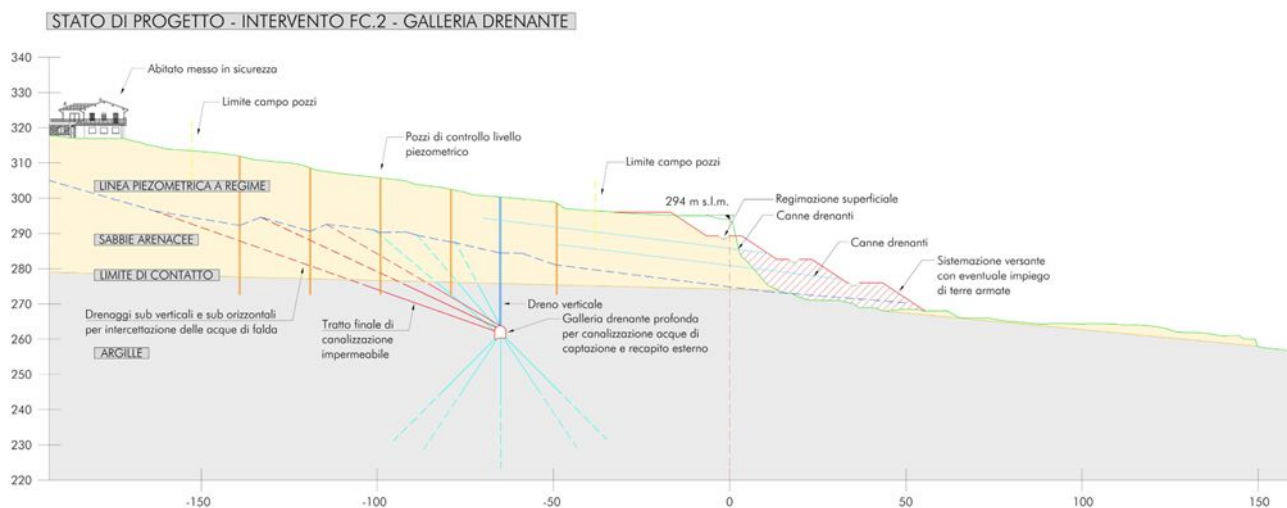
Sezione tipologica del versante in frana con galleria drenante profonda nelle argille.
